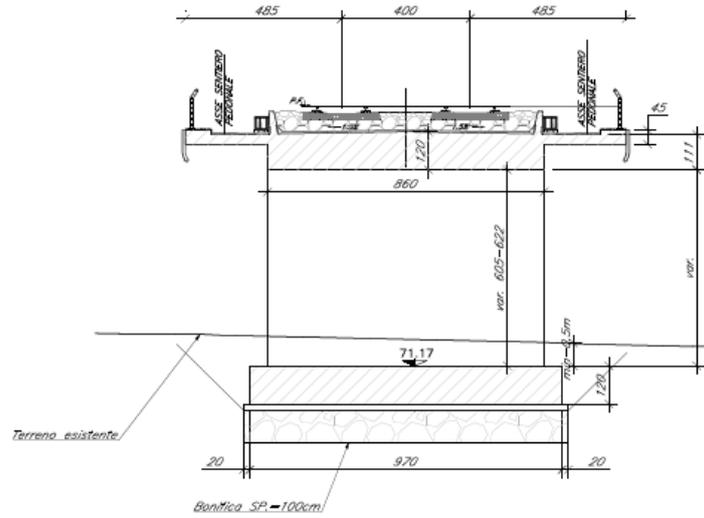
SL22 – Sezione trasversale in asse ferrovia in corrispondenza del fornice
